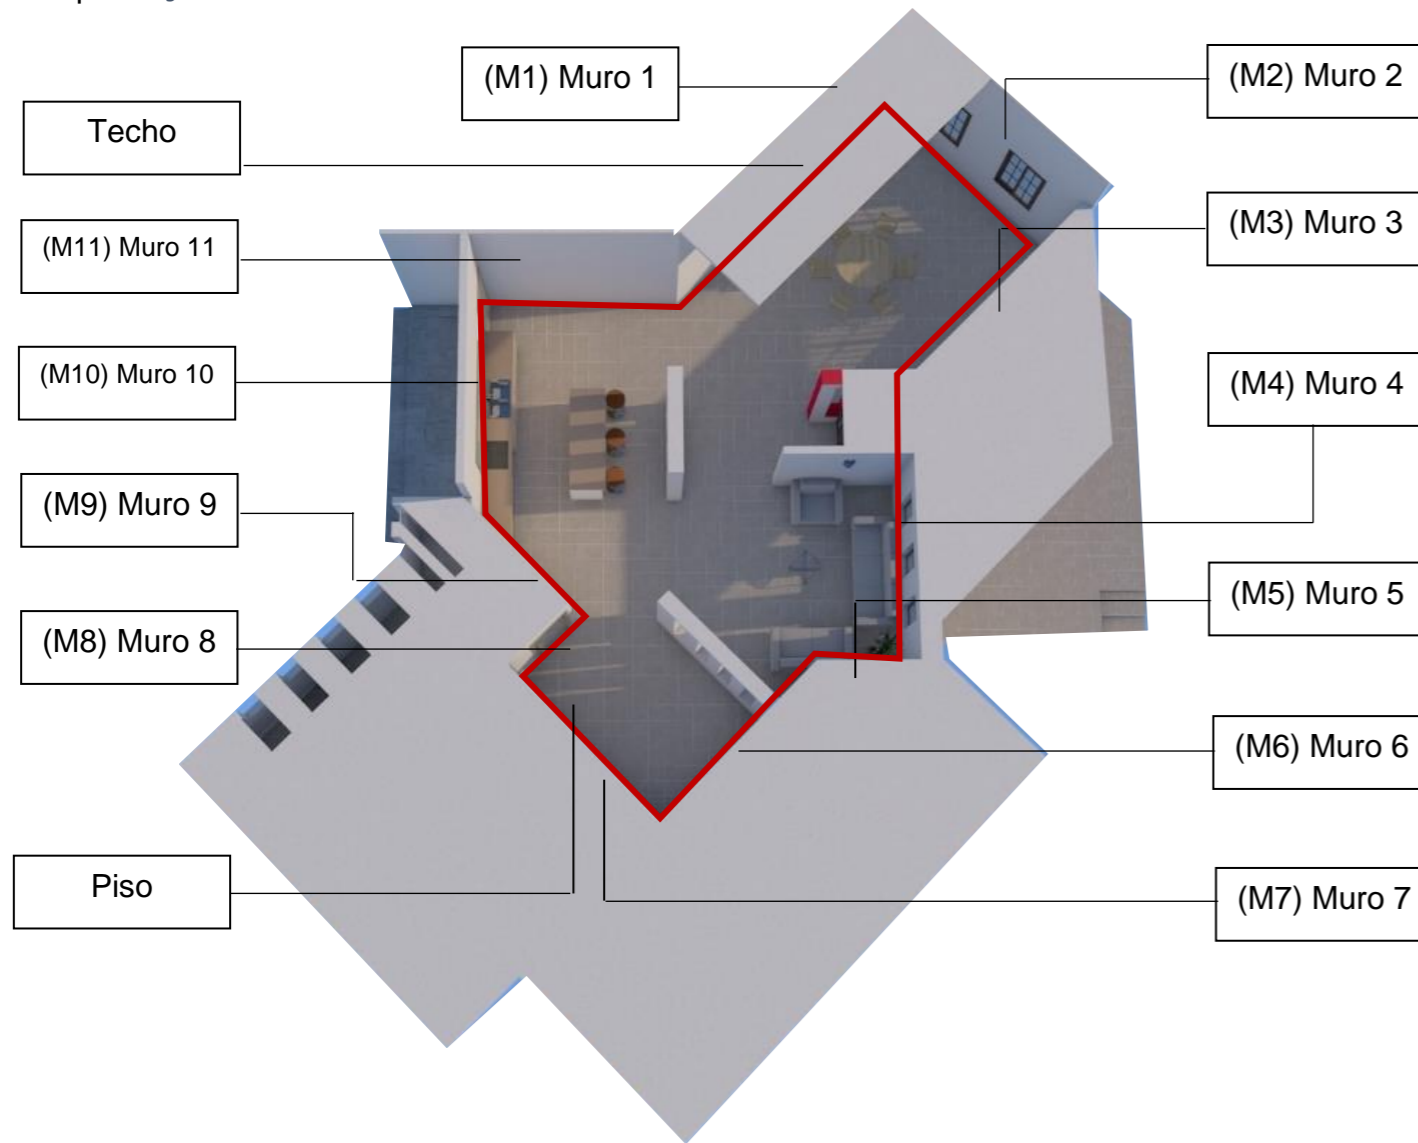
Ubicación de muros, cubierta y piso para análisis de tiempo de reverberación (propia, Elaboración)
